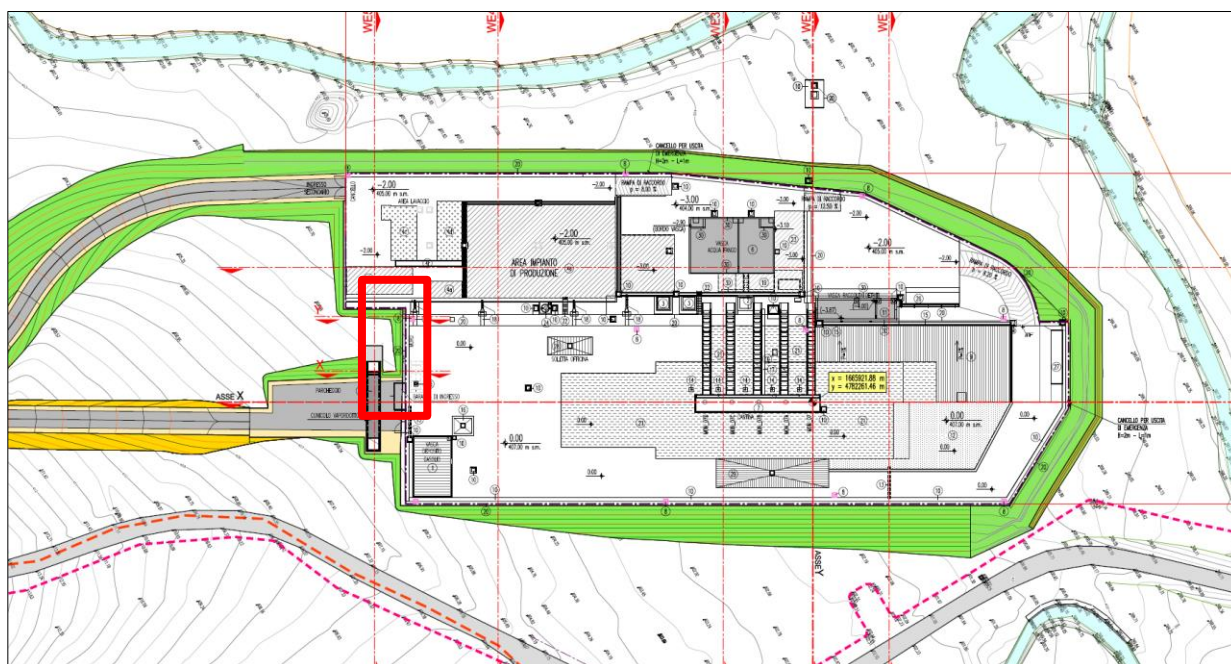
Planimetria generale di progetto con individuazione del muro in progetto.
